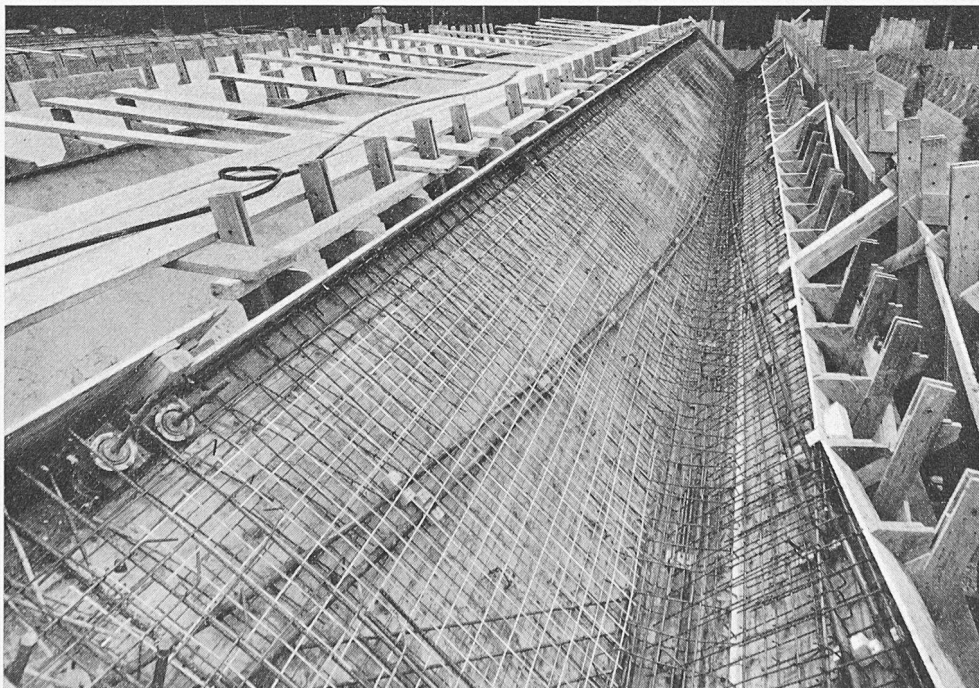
Spannkräfte und Armierung vor dem Schalen der Oberseite
